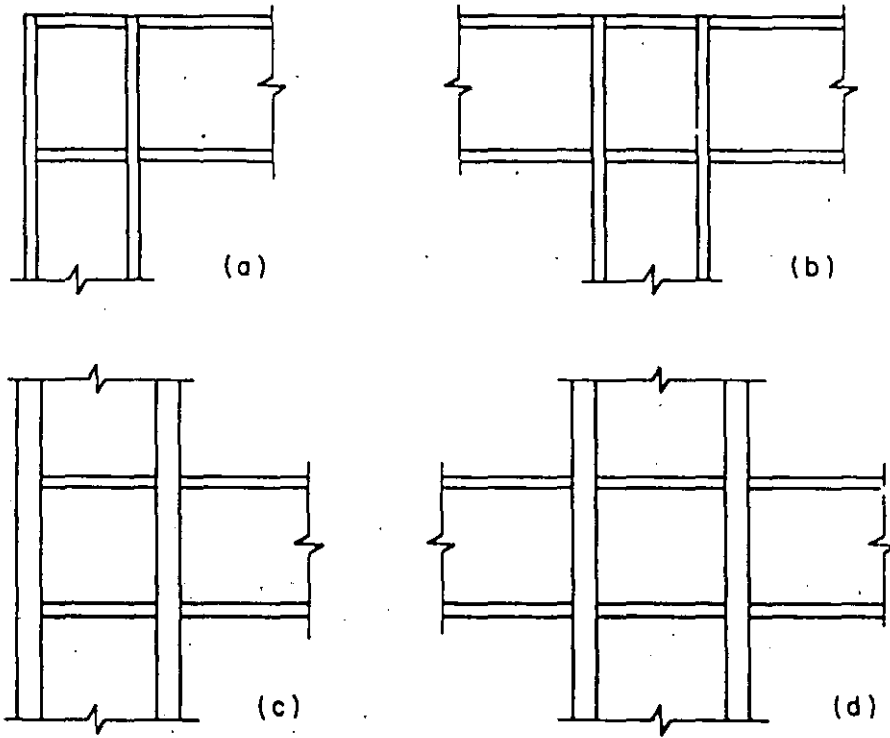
Conexiones viga-columna de marcos rígidos
